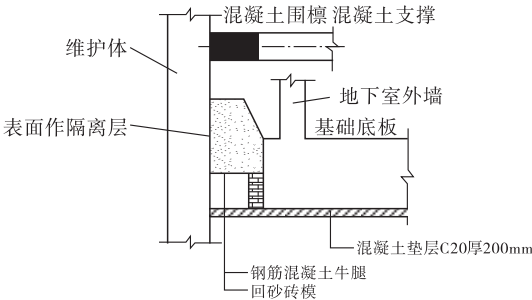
支护结构与基础底板钢筋混凝土牛腿换撑
